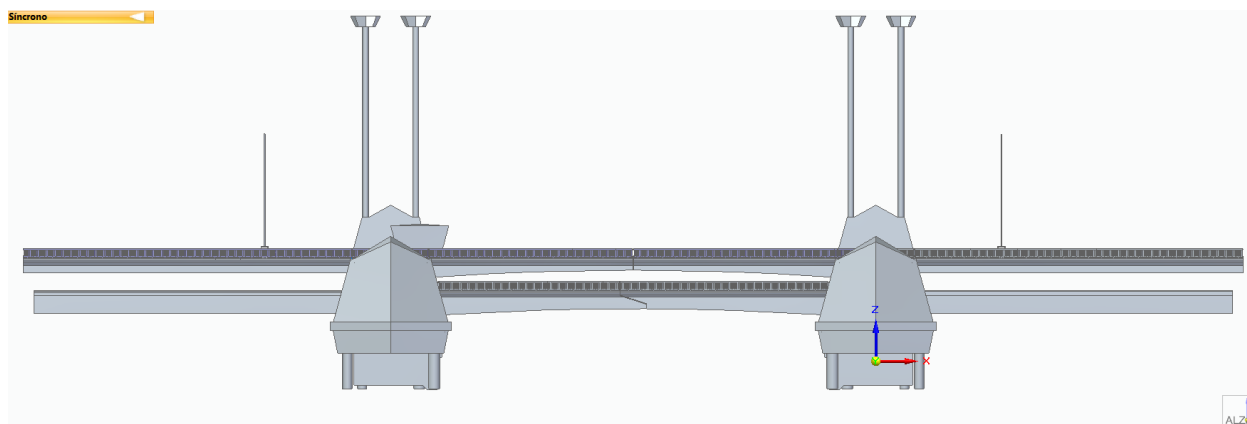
Alzado aguas arriba del puente de Las Delicias.
